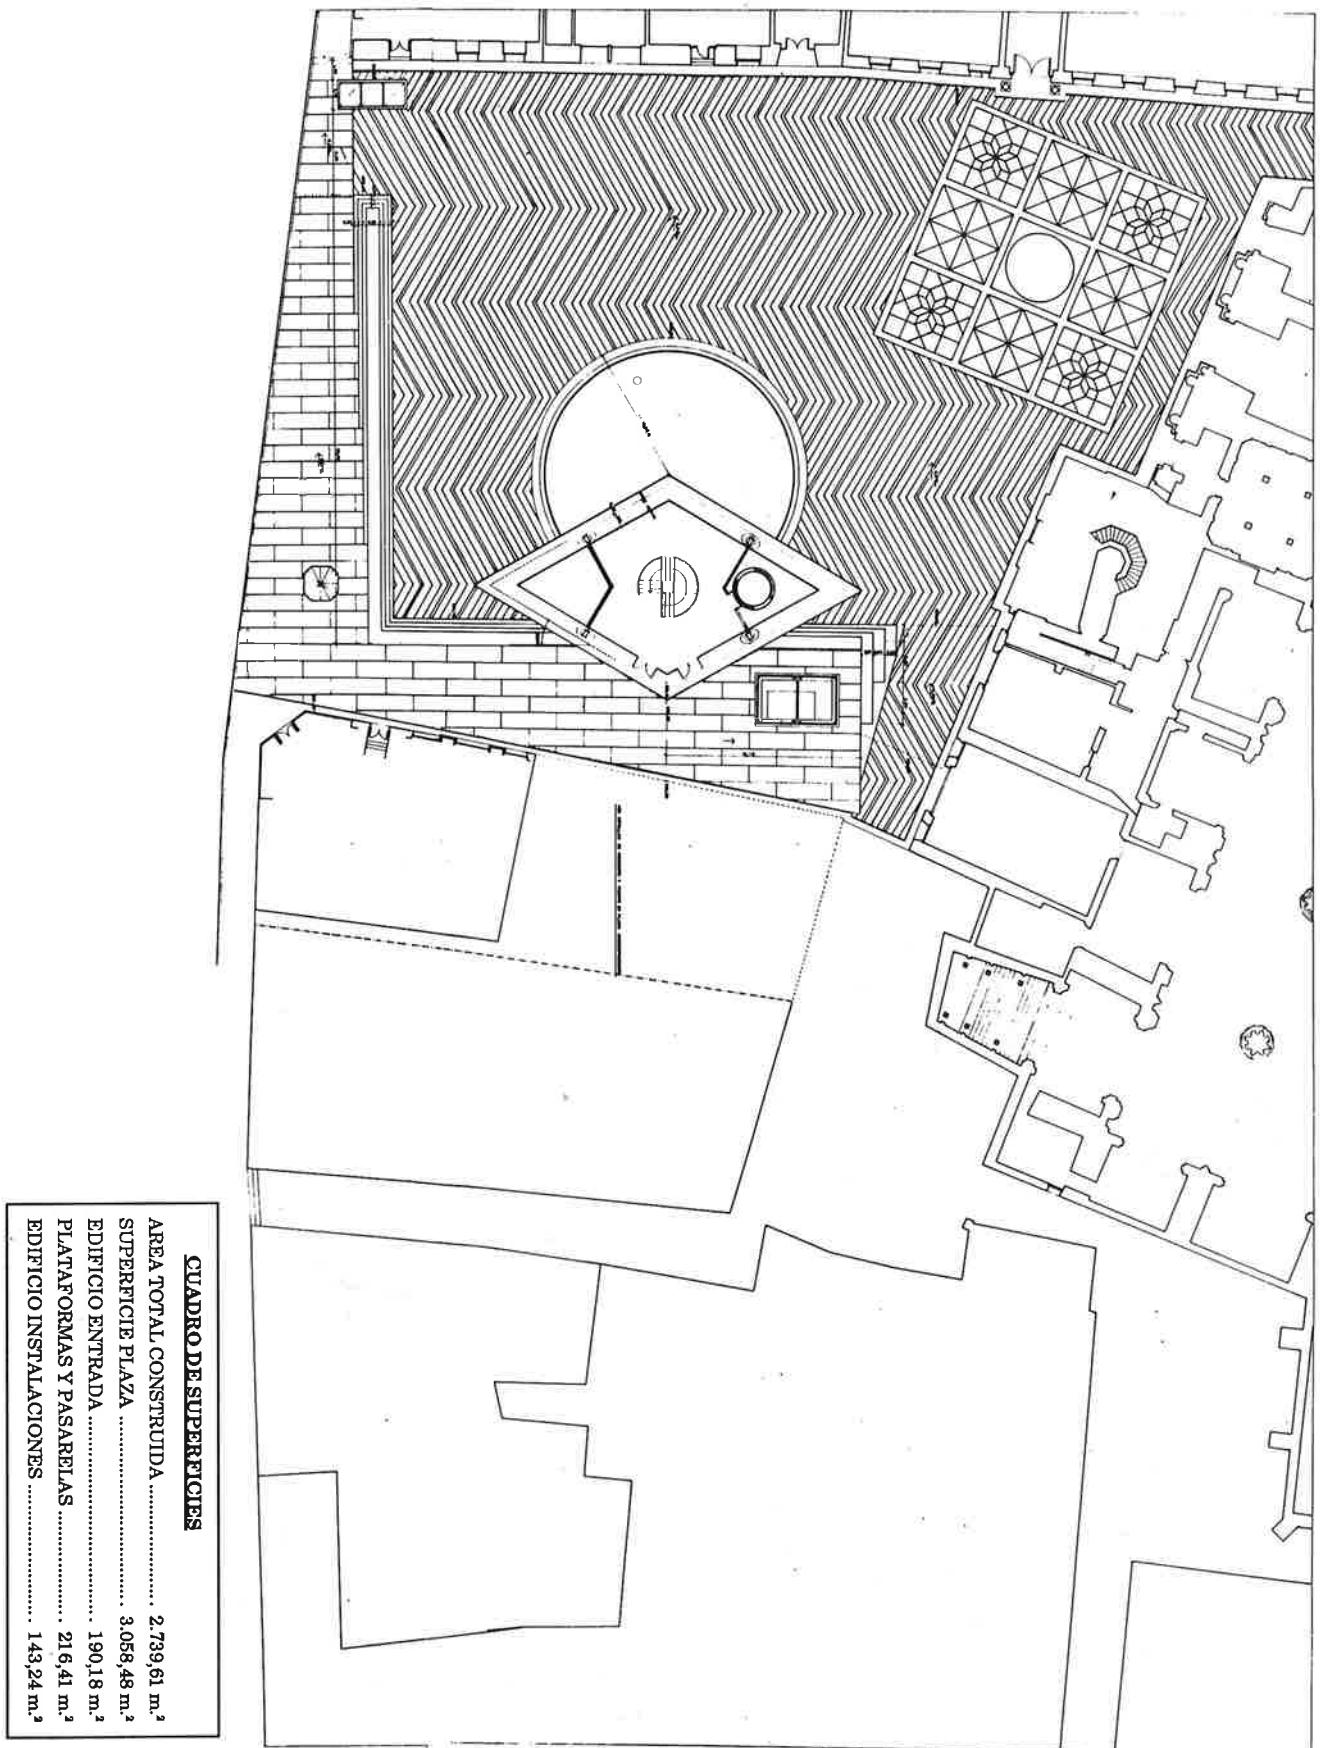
Plano n.º 19: Visión planimétrica de las estructuras arquitectónicas y pavimentos proyectados.
